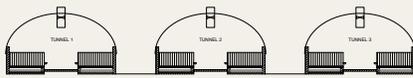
VUE EN COUPE D'UN BÂTIMENT VEAUX DE BOUCHERIE EN AIRE PAILLÉE
